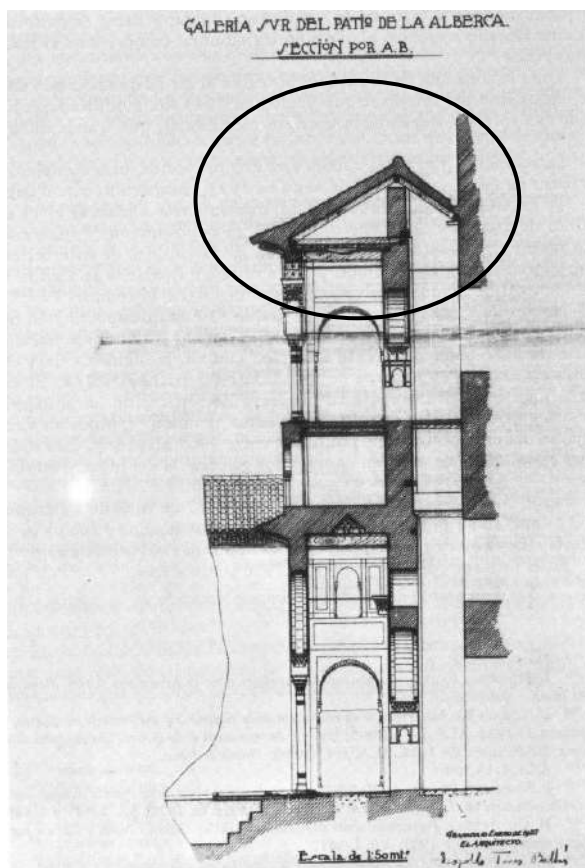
Proyecto de Reparación de la nave sur del Patio de la Alberca. Estado propuesto. Torres Balbás, 1927. (*La Alhambra de Leopoldo Torres Balbás (Obras de restauración y conservación. 1923-1936)*).
